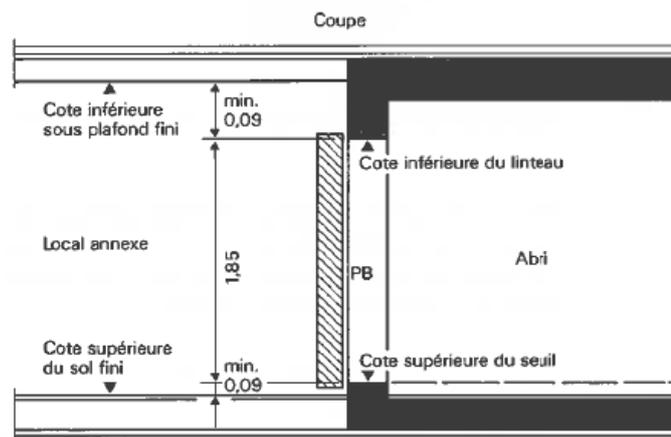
Dimensions de montage des portes blindées, en coupe verticale (dimensions minimales)
